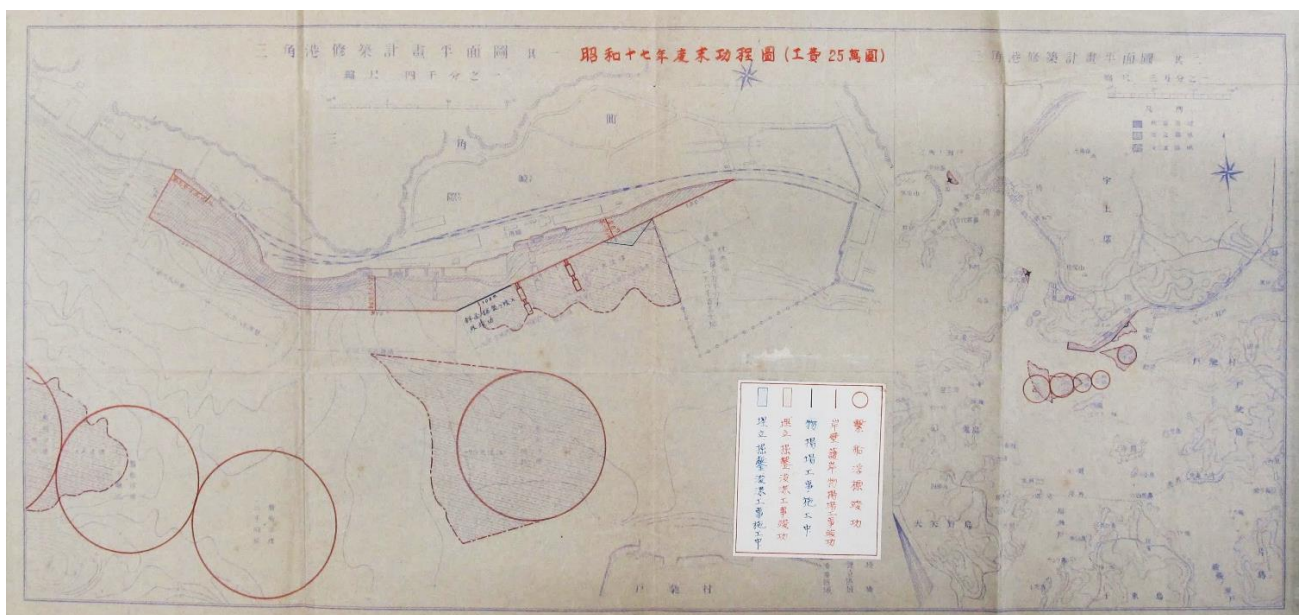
三角港修築計画平面図 昭和17年度末工程図 (工費25万円)
